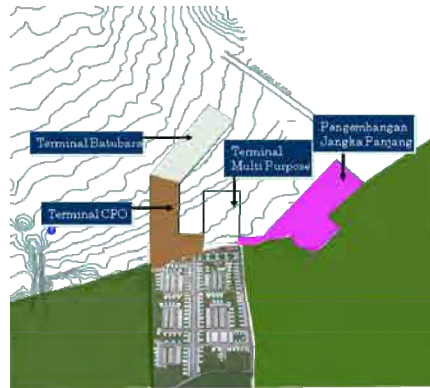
Rencana Pembangunan Pelabuhan Marunda (KBN)
